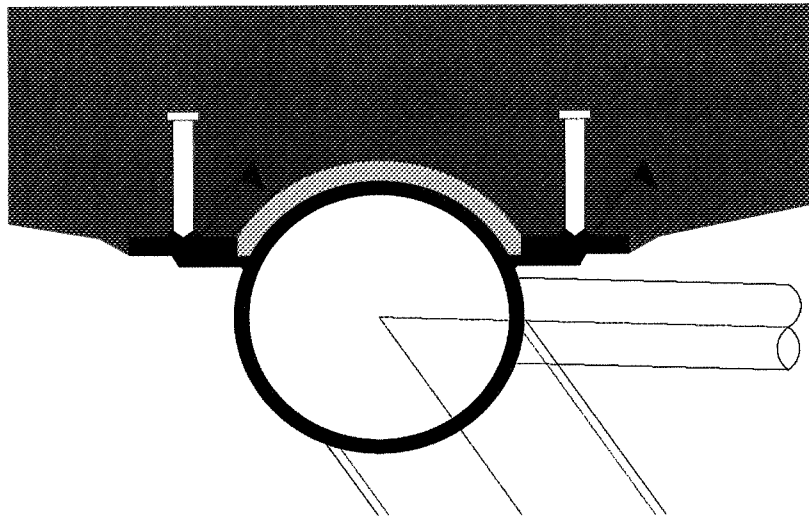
Verbundfuge Stahl – Beton bei der Talbrücke Dättwil
